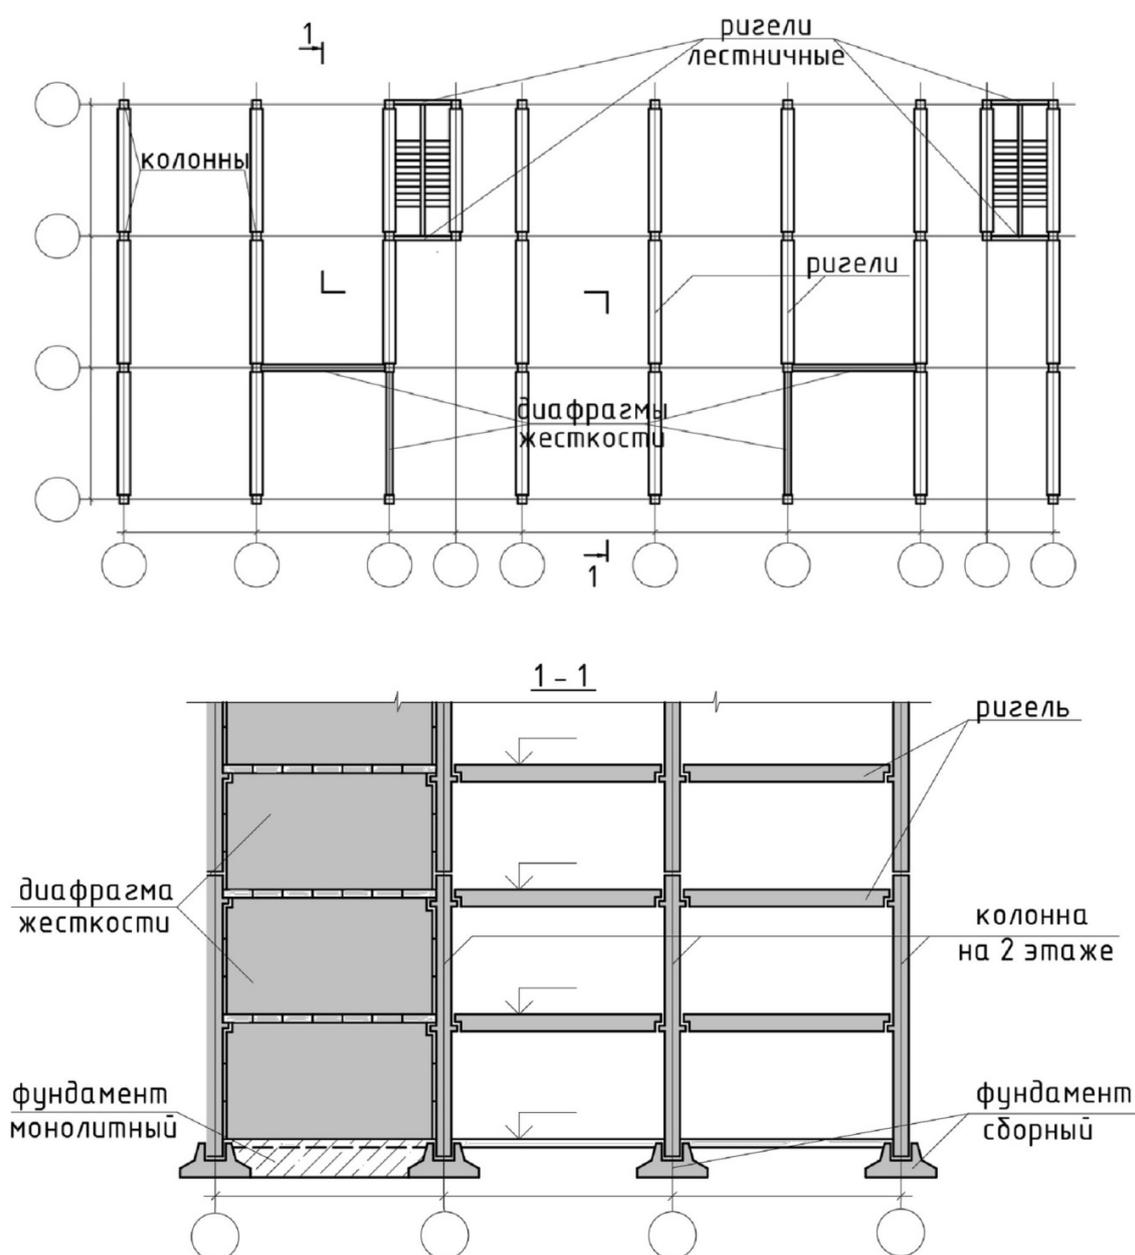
Монтажный план конструктивных элементов каркаса
